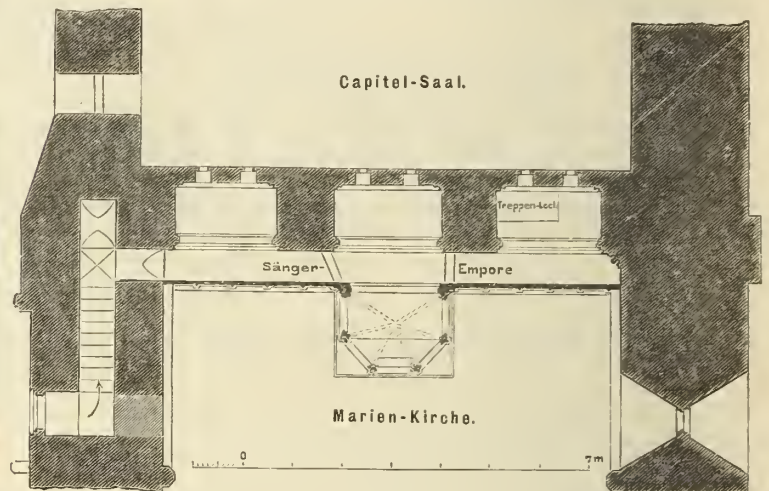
Westwand der Kirche. — Emporen-Grundriss.
